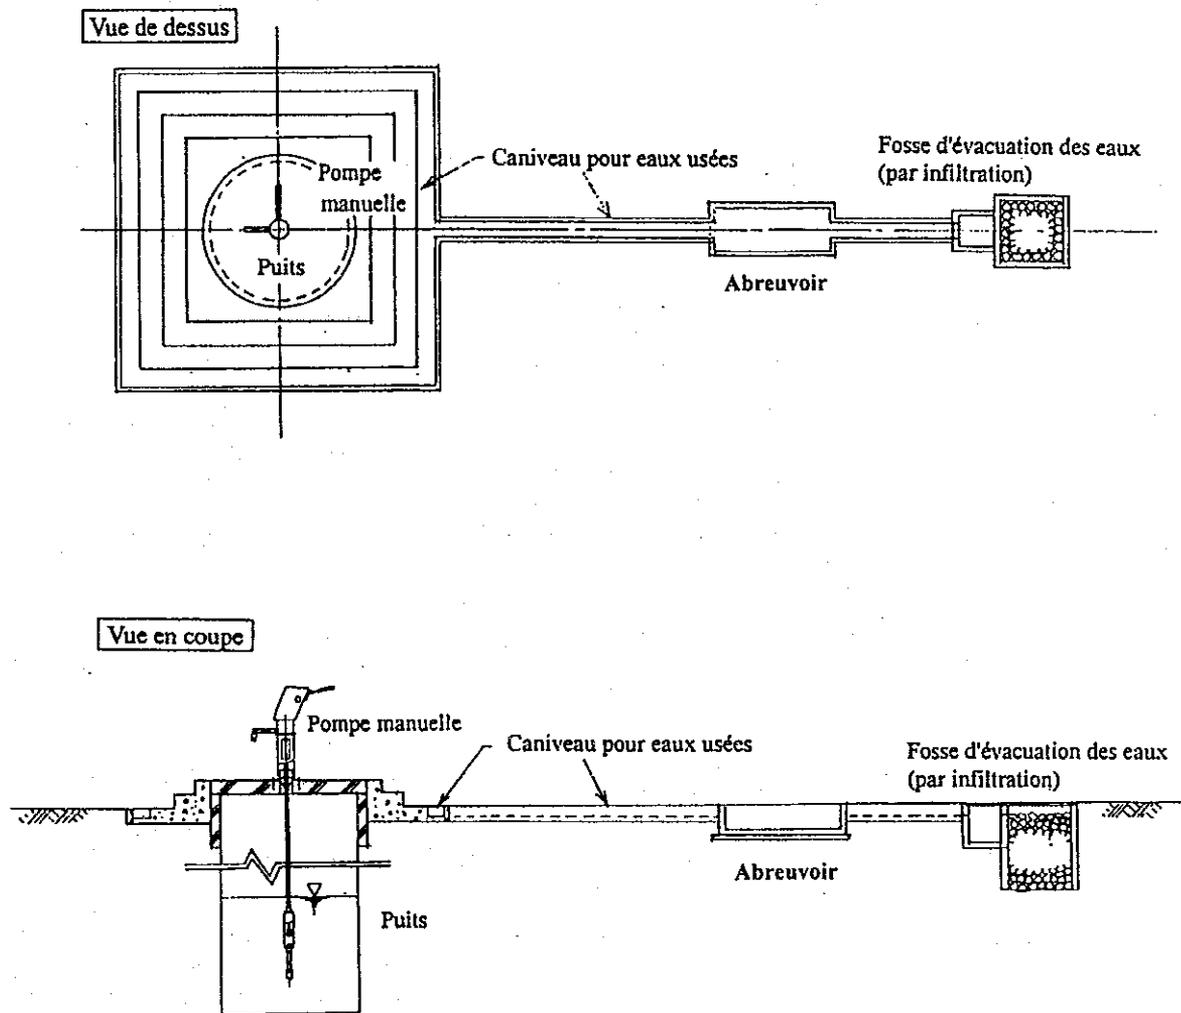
Installation d'Alimentation en Eau par Pompe Manuelle
